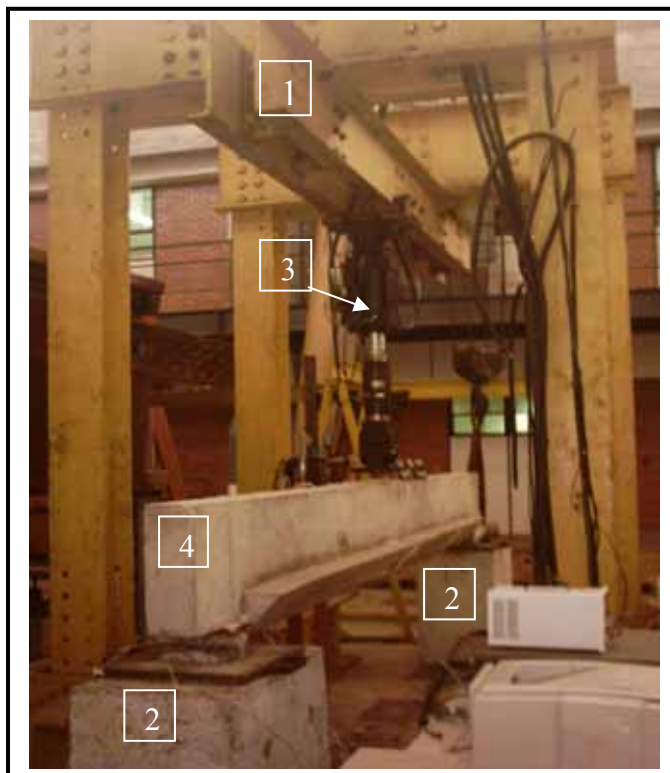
Elementos do esquema de ensaio de uma viga: pórtico (1), apoios (2), macaco hidráulico (3) e viga (4).
